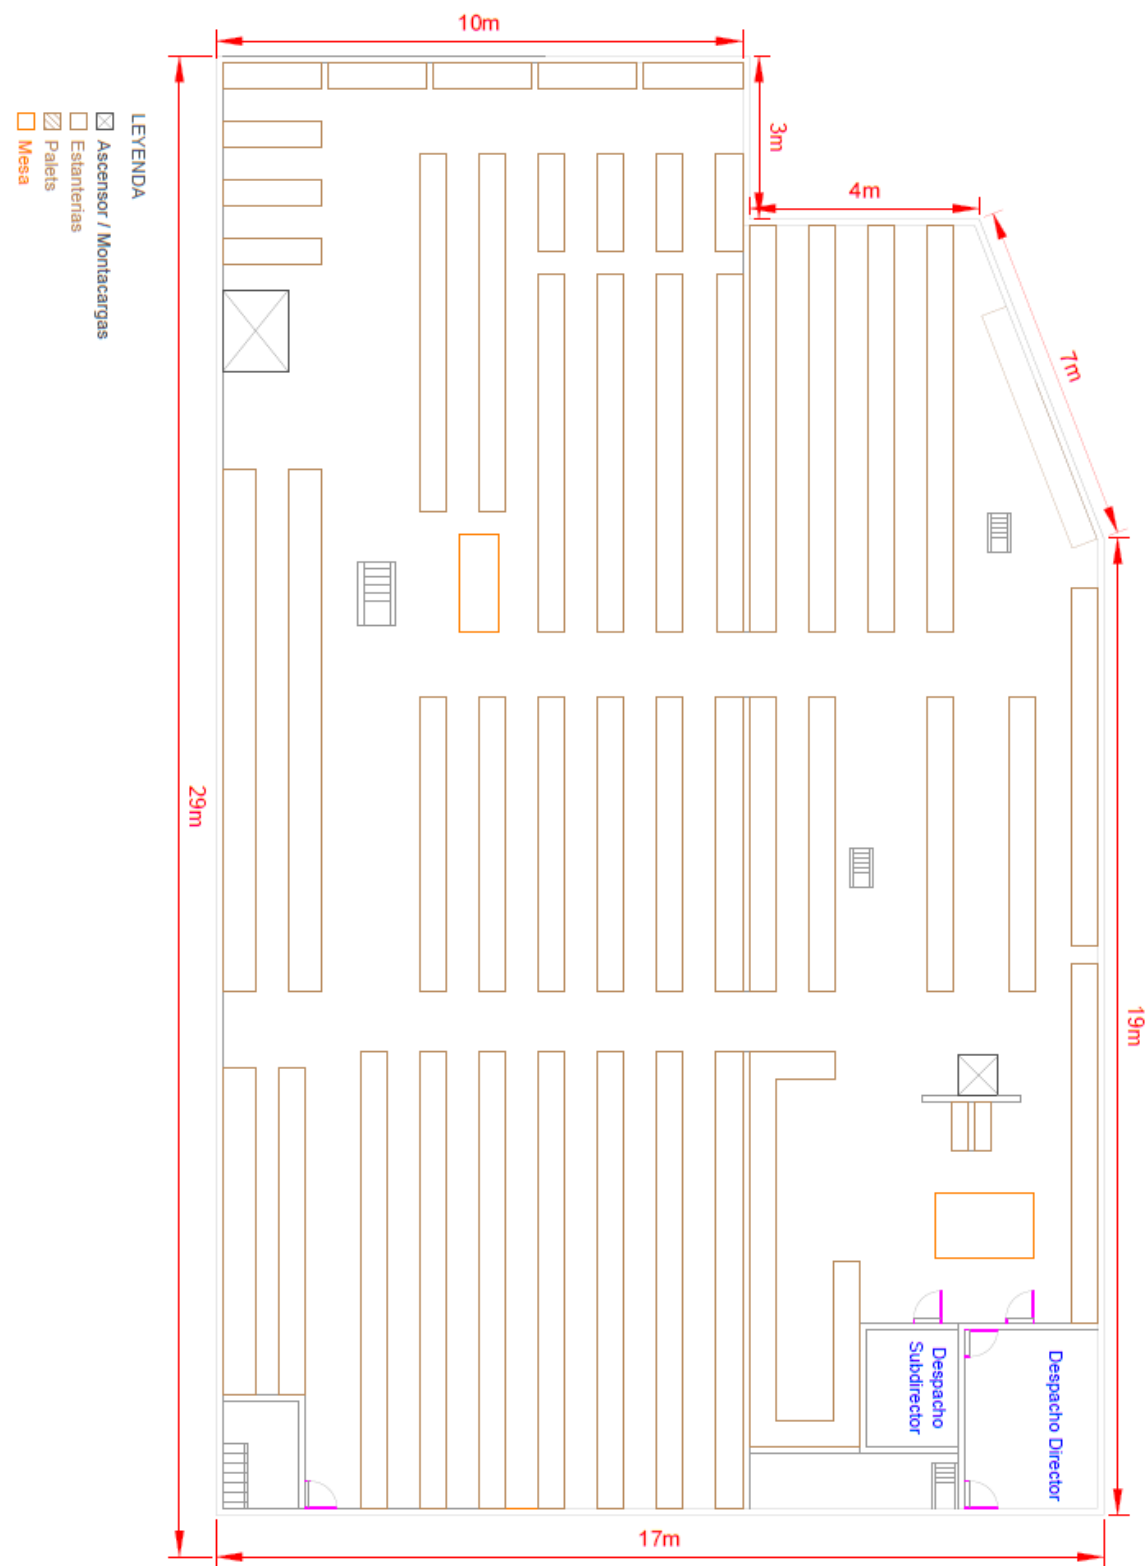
Imagen del plano de la primera planta (Anexo D: P002)
